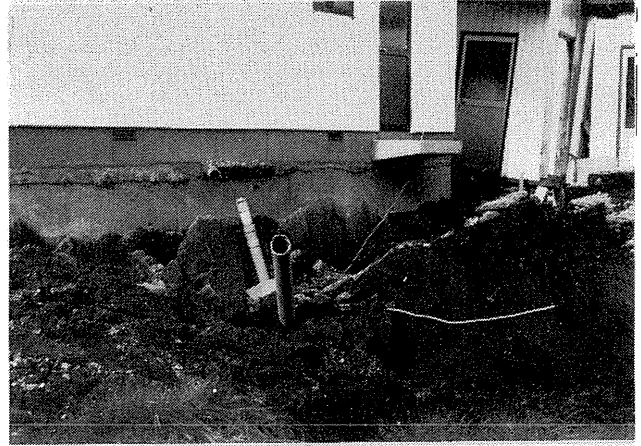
南6丁目地区の建物の被害(その1)
